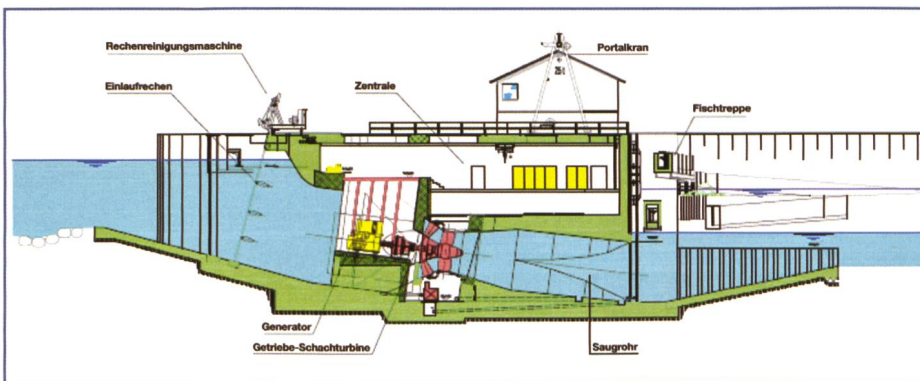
Schnittbild durch die neue Maschinenzentrale mit der Getriebeschachtturbine.
